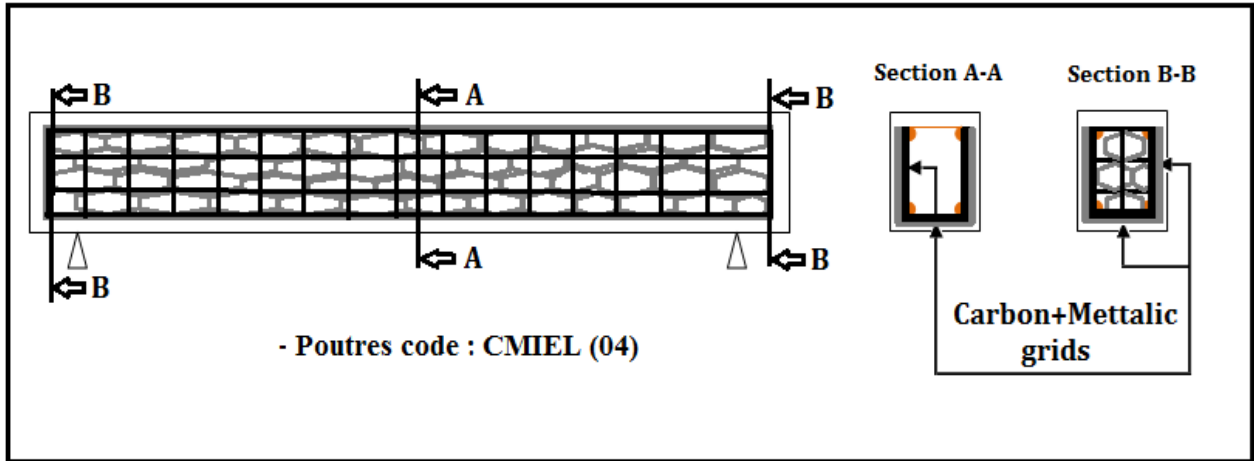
d : Détails de renforcement des poutres du groupe 04.
